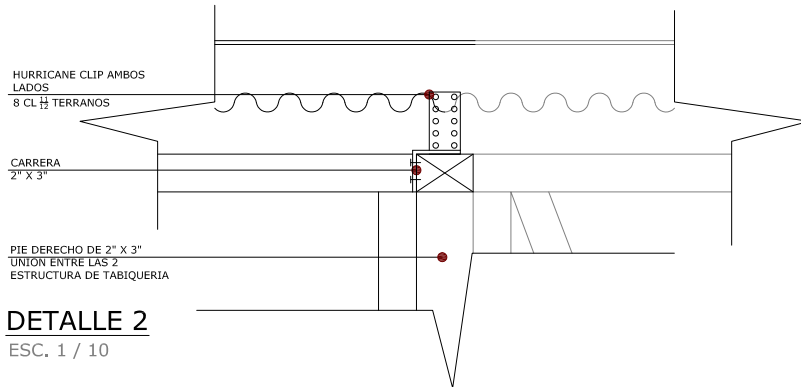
Despiece de los componentes de la estructura de cubierta y entramado de 2º piso
